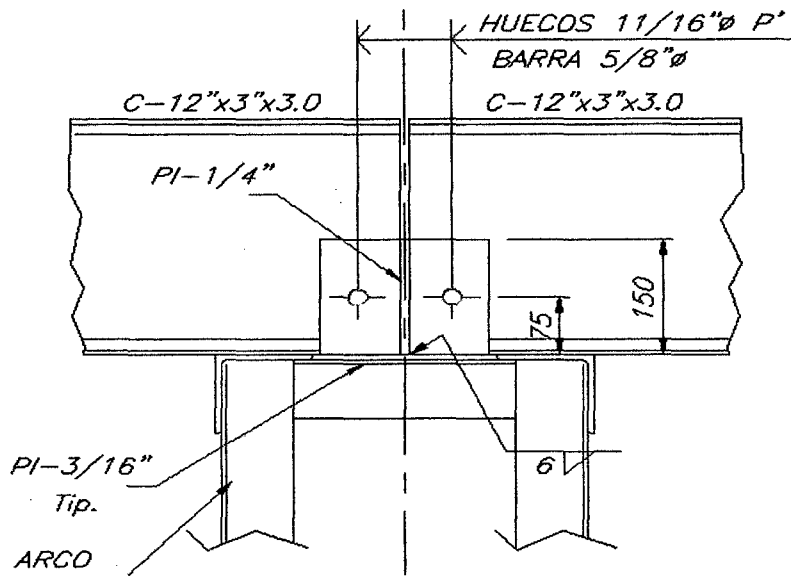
Detalle del anclaje de las Vigas c sobre el arco.
